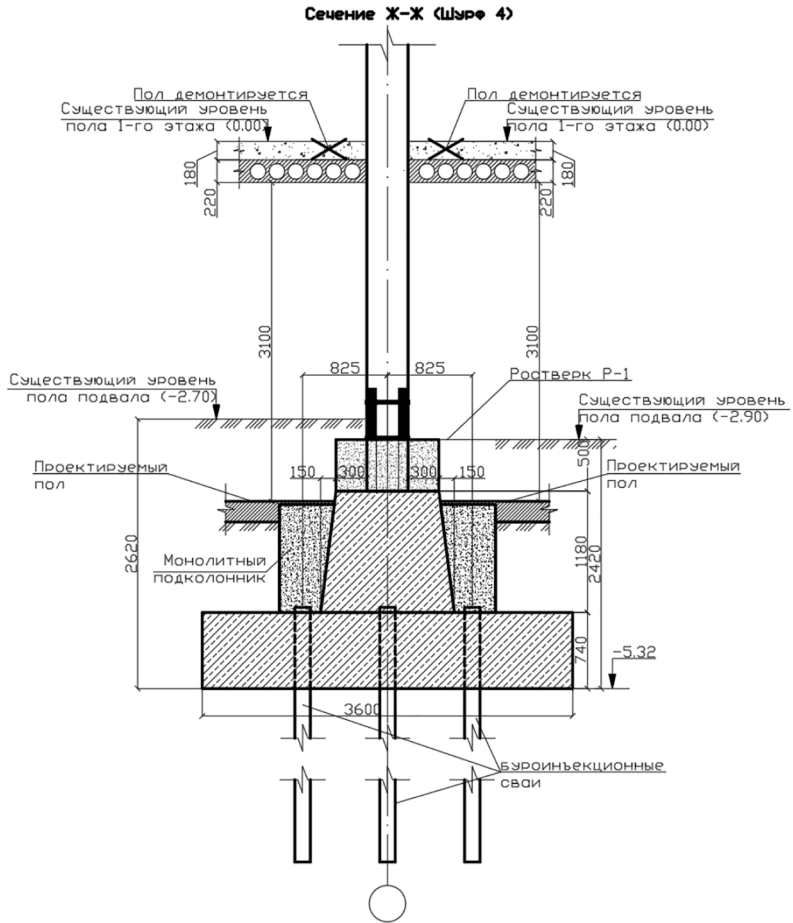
Поперечное сечение Ж-Ж усиленного основания фундамента
